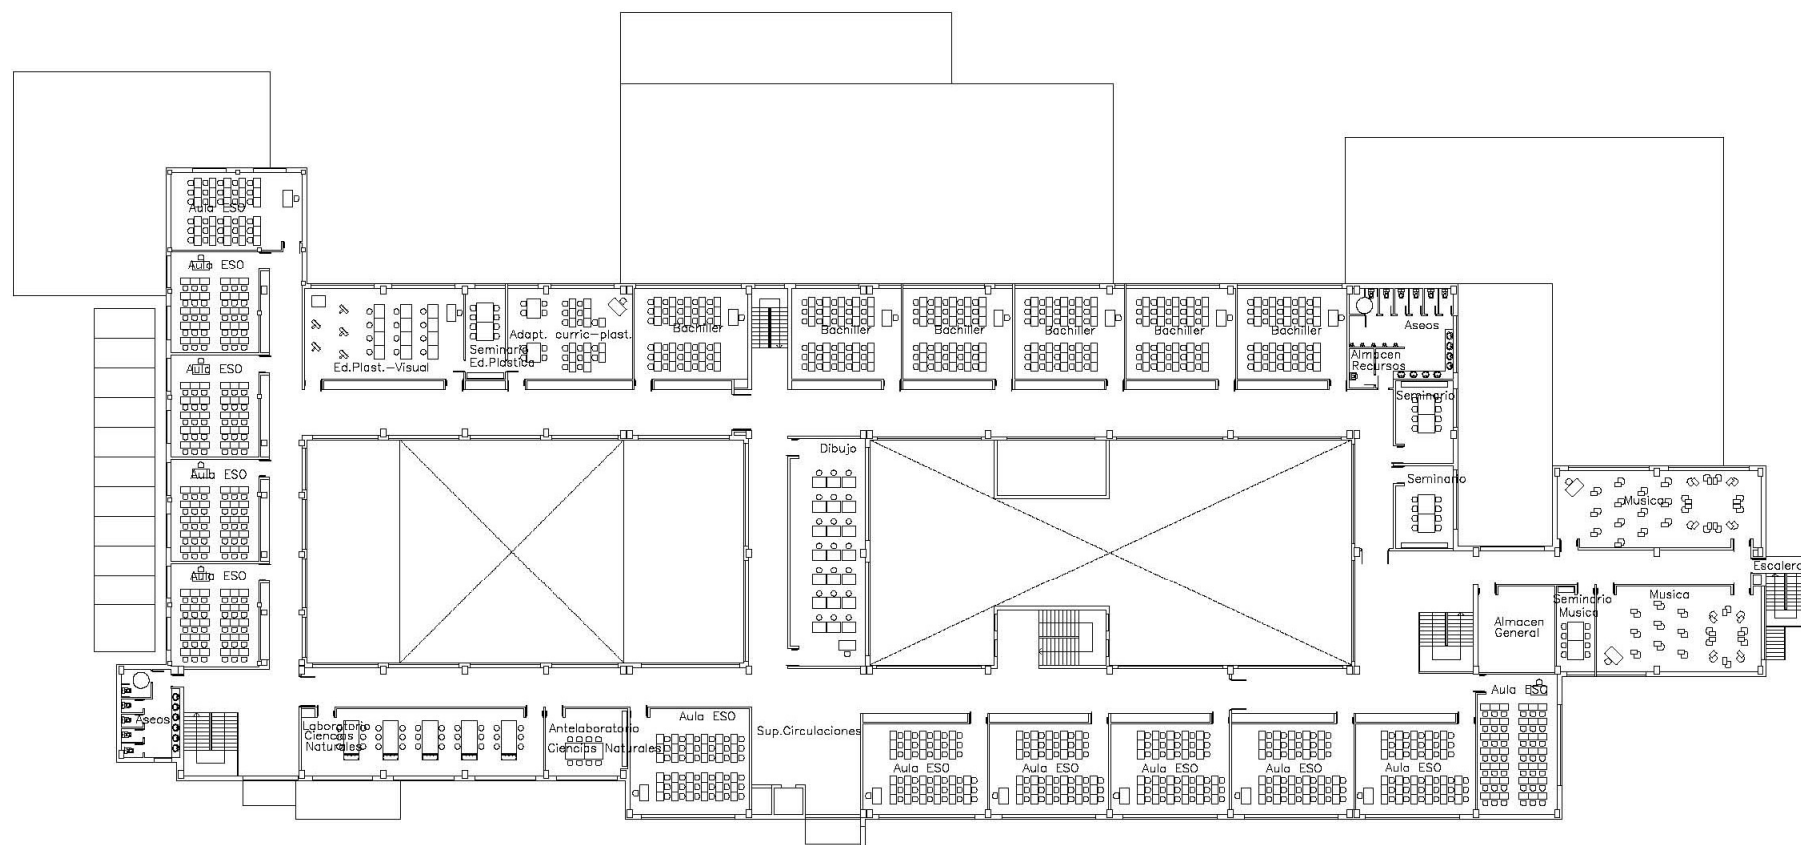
Plano de distribución Planta 2ª (Fuente: proyecto)
